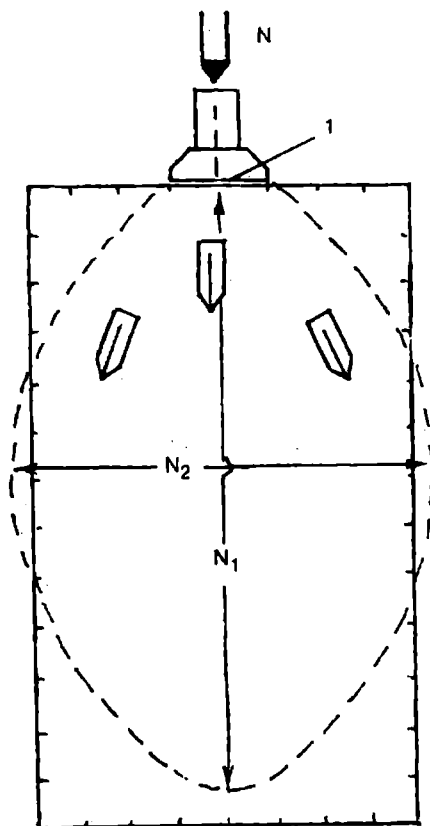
Формирование напряженной зоны грунта под подошвой фундамента:
